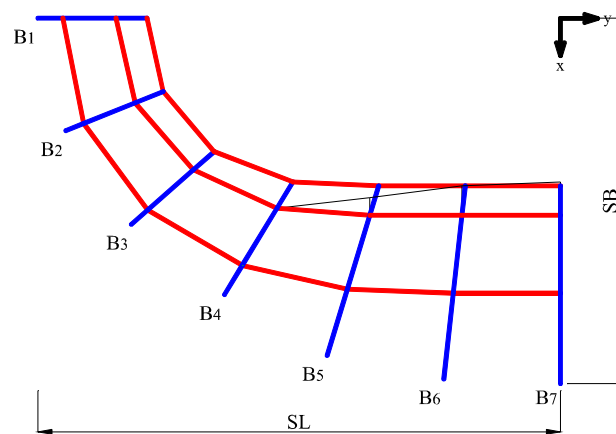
Überdachung einer Radrennbahn, Grundriss Viertelsegment
